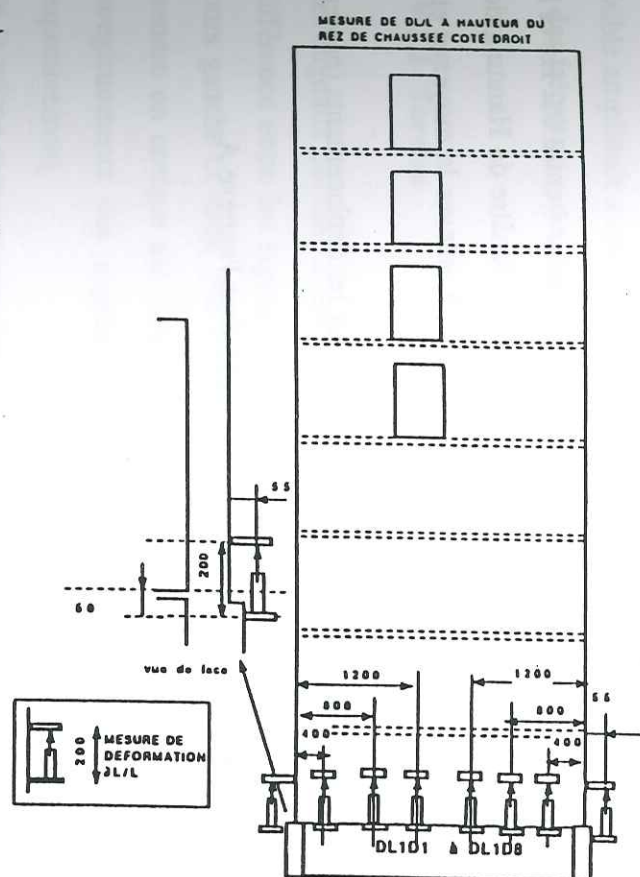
Dispositif de mesure de l'ouverture des fissures au rez-de-chaussée (Gantenbein et al., 1994)
